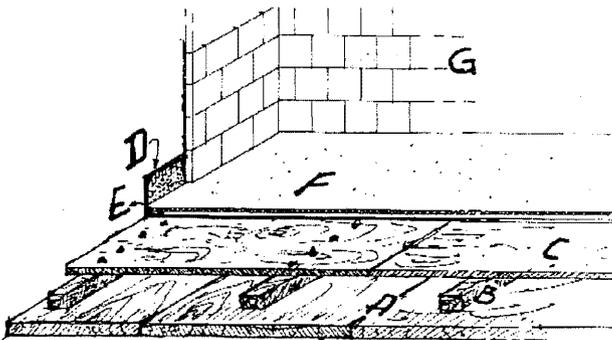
Alzado del piso de un solar en madera para su ventilación.
